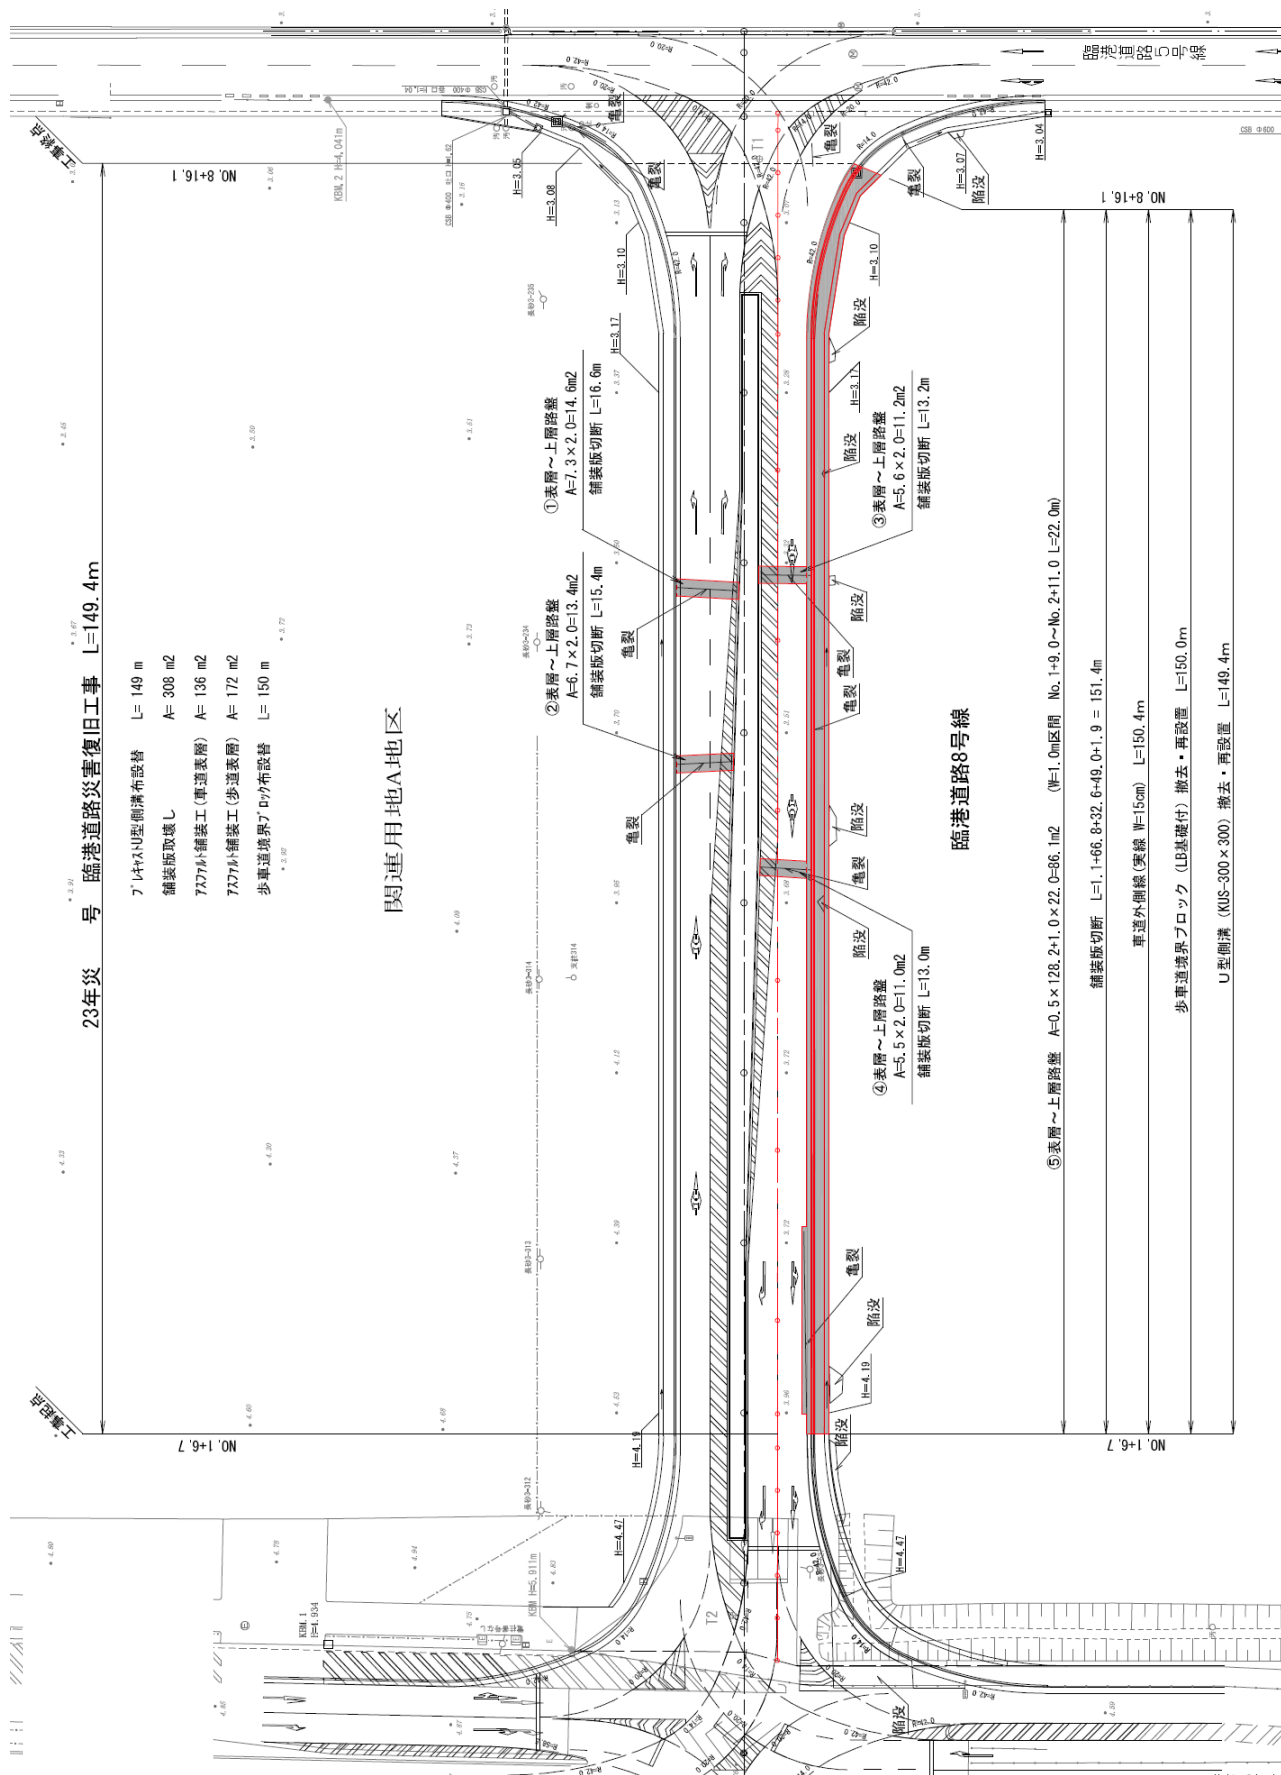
No.10 常陸那珂港区\_臨港道路8号線の平面図(復旧後)
